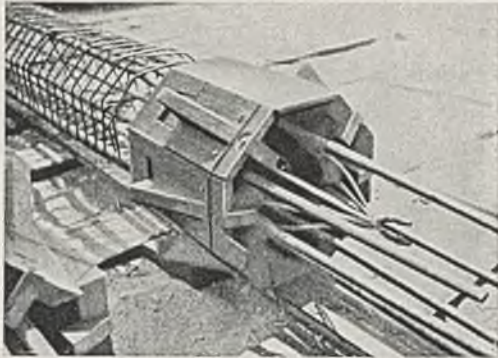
Einbindung der Stahlgußkonstruktion in die Eisenbewehrung.
